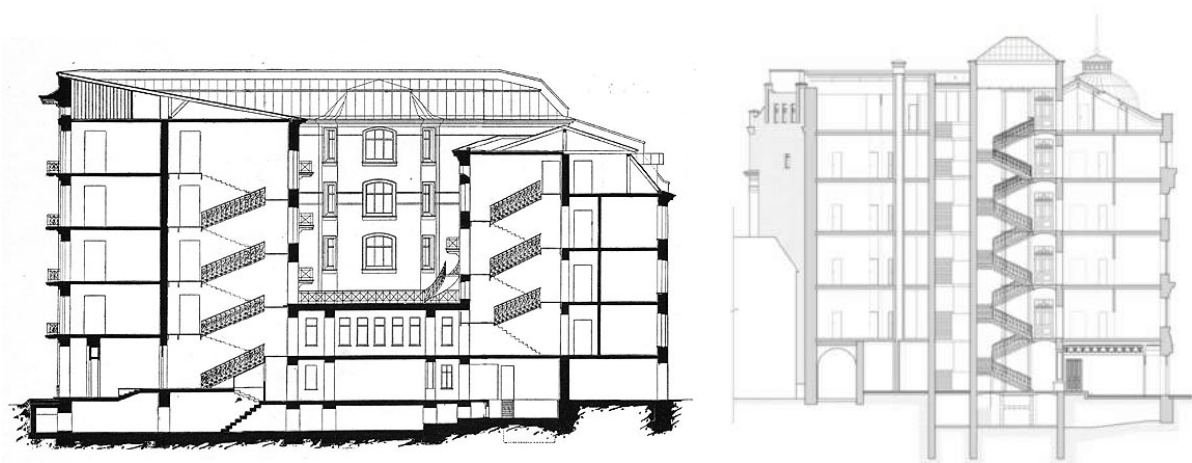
Слева - разрез доходного дома Г.В. Барановского, 1897 г., арх. Г.В. Барановский, г. Санкт-Петербург, справа – разрез доходного дома М.М. Тюляевой, 1910 г., арх. К.Л. Розенкамф, г. Москва
